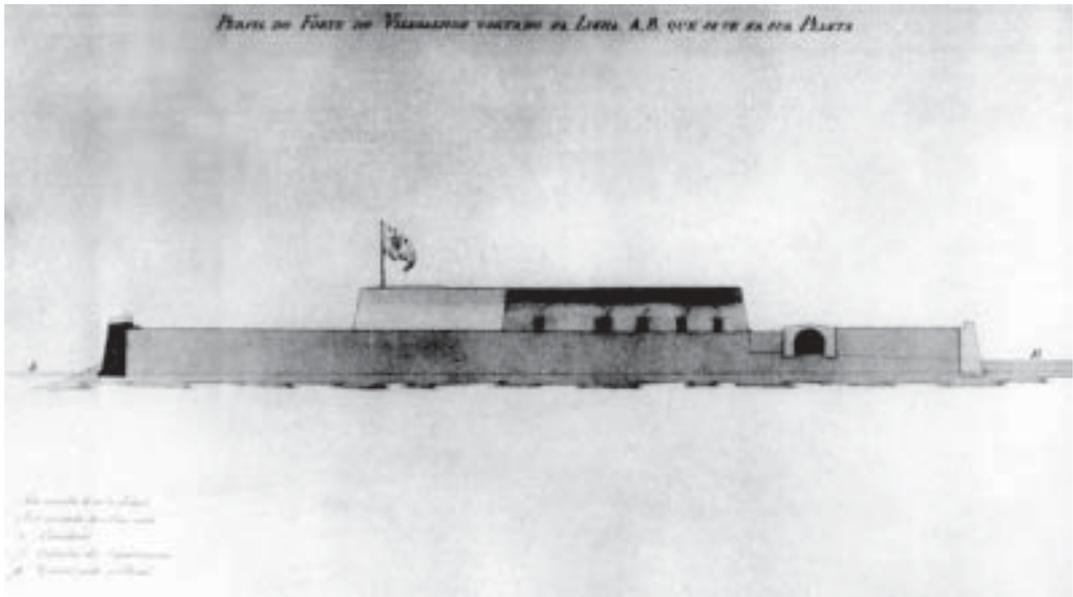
Planta com perfil da Fortaleza de Villegagnon – Jacques Funck, 1781
